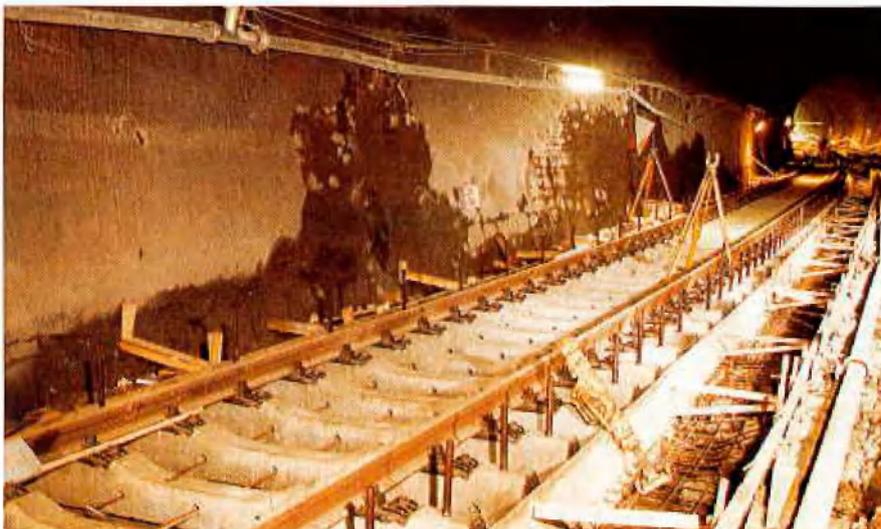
Fertiggestellter 1. Bauabschnitt am Westportal des Tunnels Herchen
